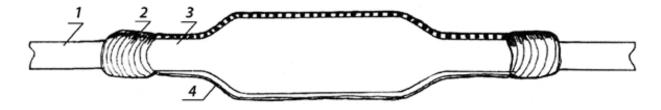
Подготовка к усадке наружной манжеты: 1 – наружный шланг кабеля; 2 – закрытые полиэтиленовой лентой участки брони с бандажами и припаянными концами проводов; 3 – усаженная внутренняя манжета.
